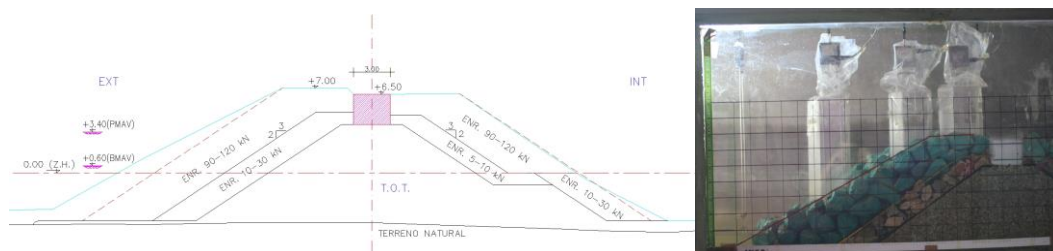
Vista transversal da secção em estudo do quebra-mar e da estrutura no canal de ondas
